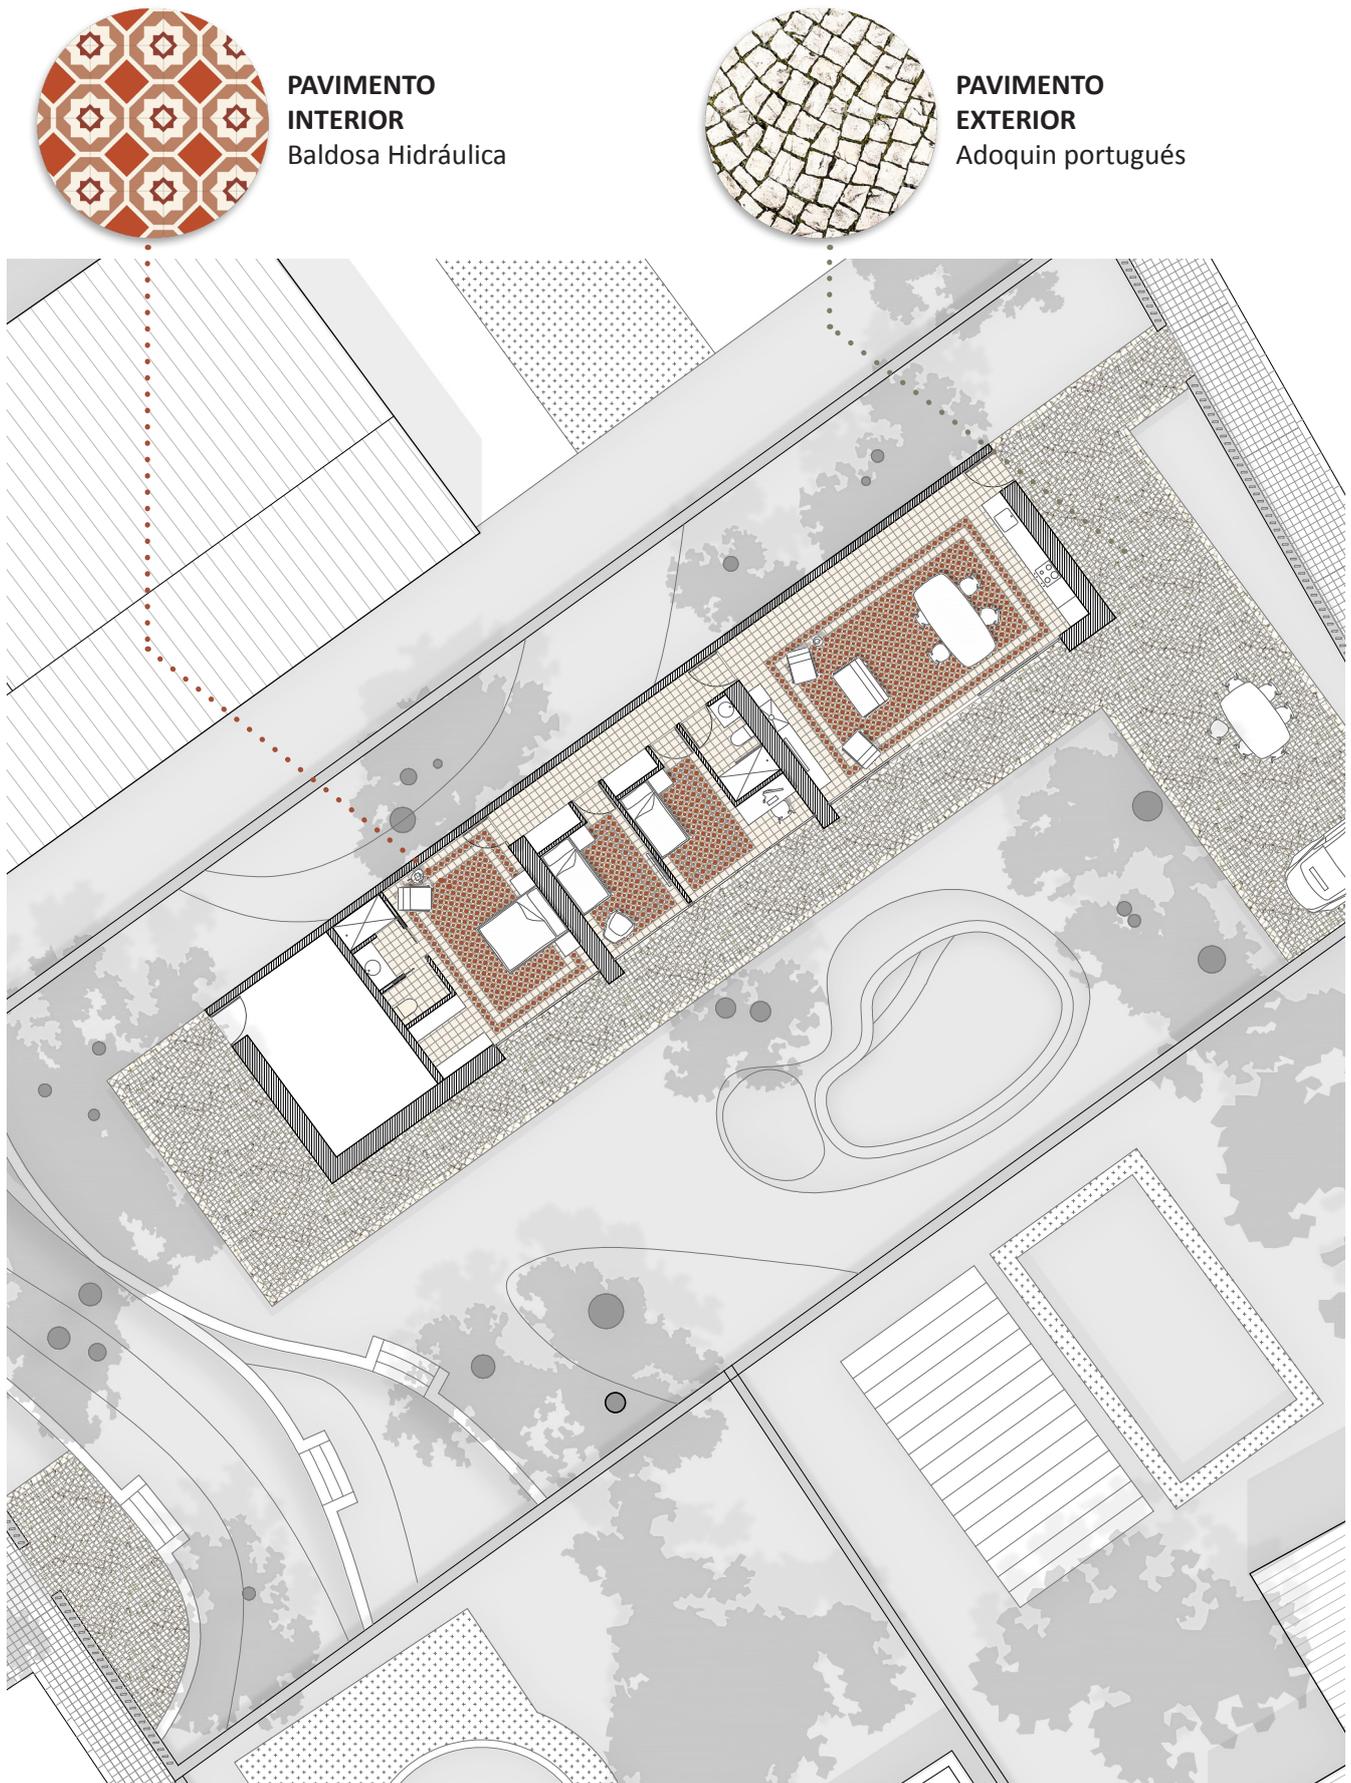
Plano de los pavimentos. 2018. Fuente propia.
